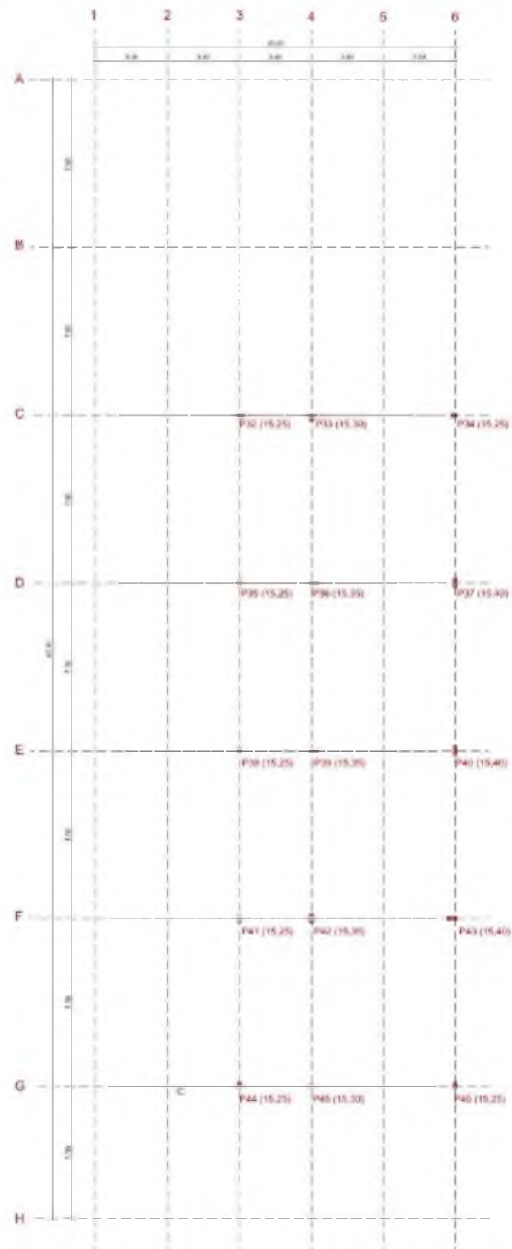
Planta de Alocação de Pilares do pavimento superior
